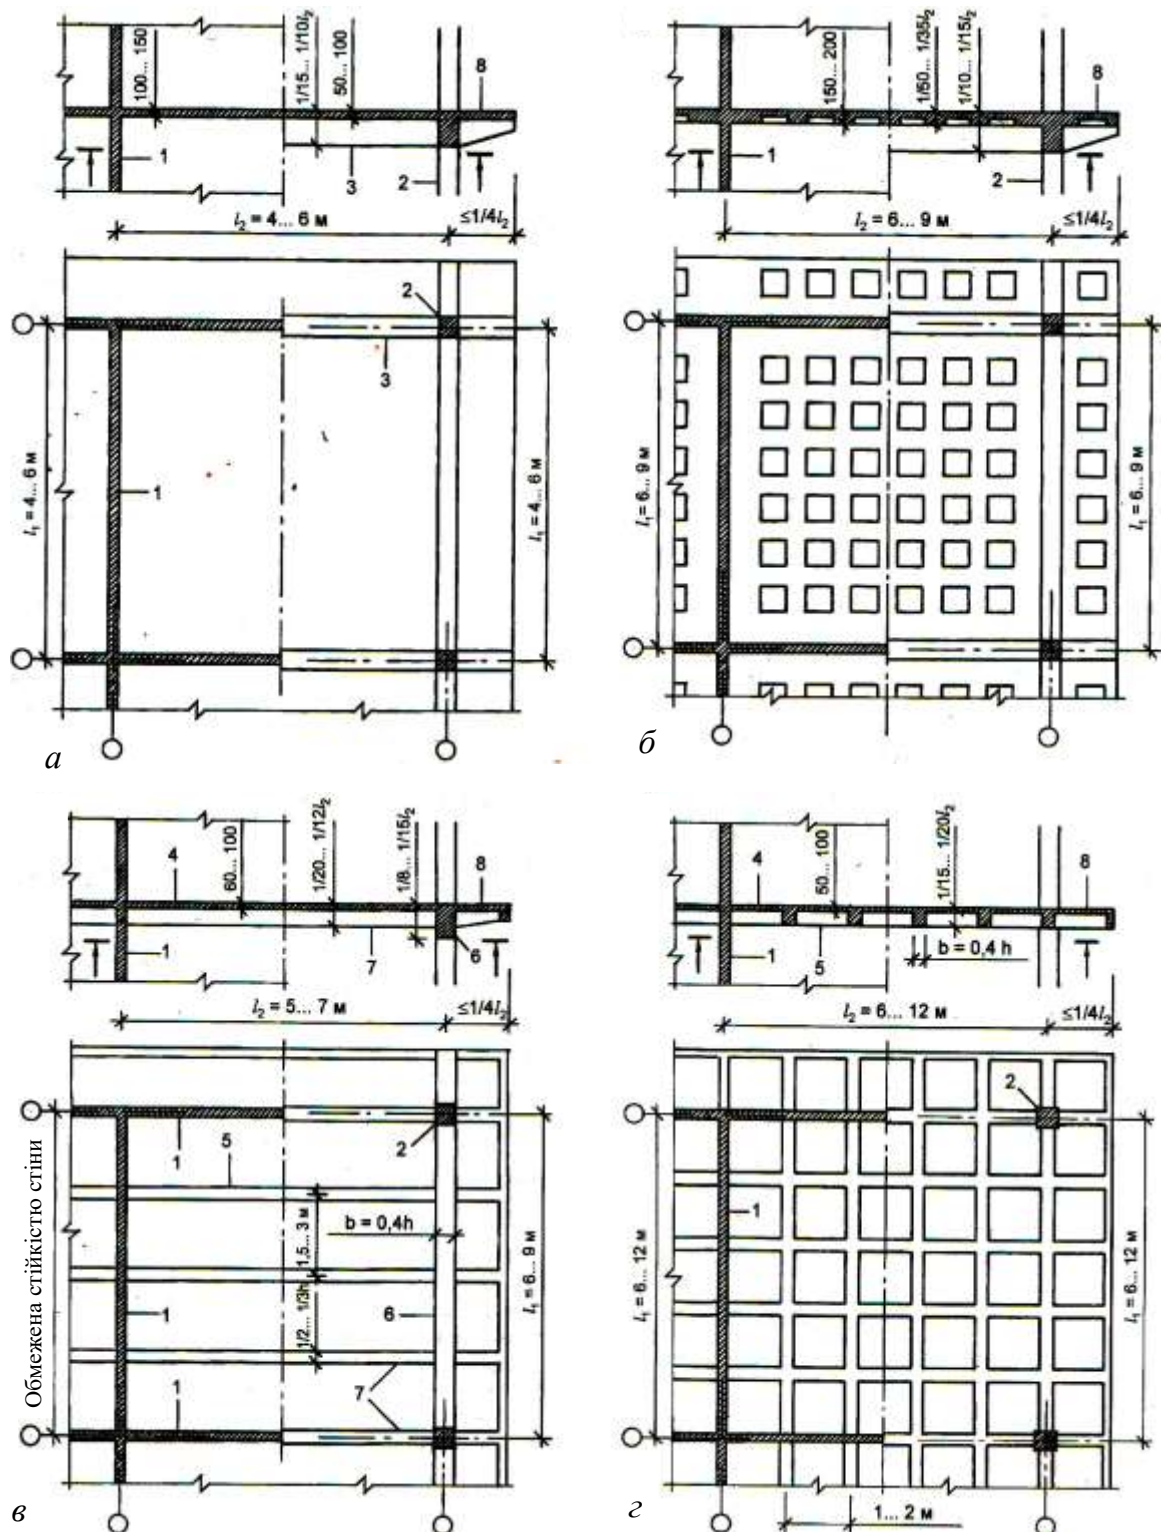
Види монолітних перекриттів в будівлях стінової та каркасної конструктивних систем:
